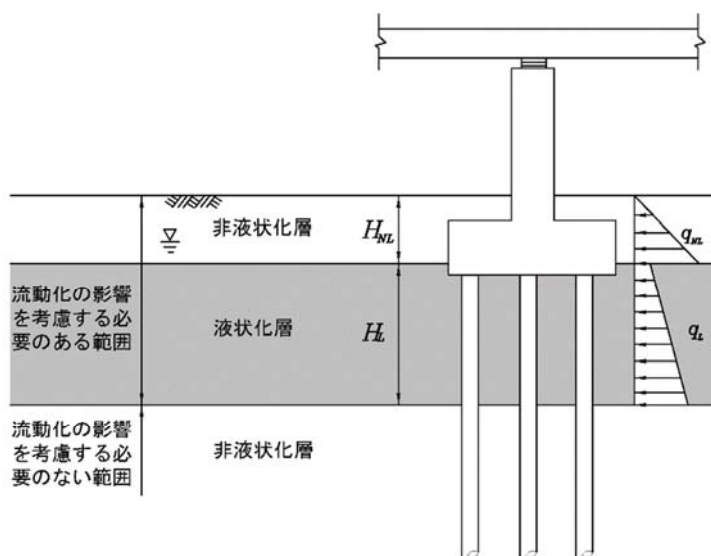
流動力の算定モデル（道示V編, 図-4.4.1）
